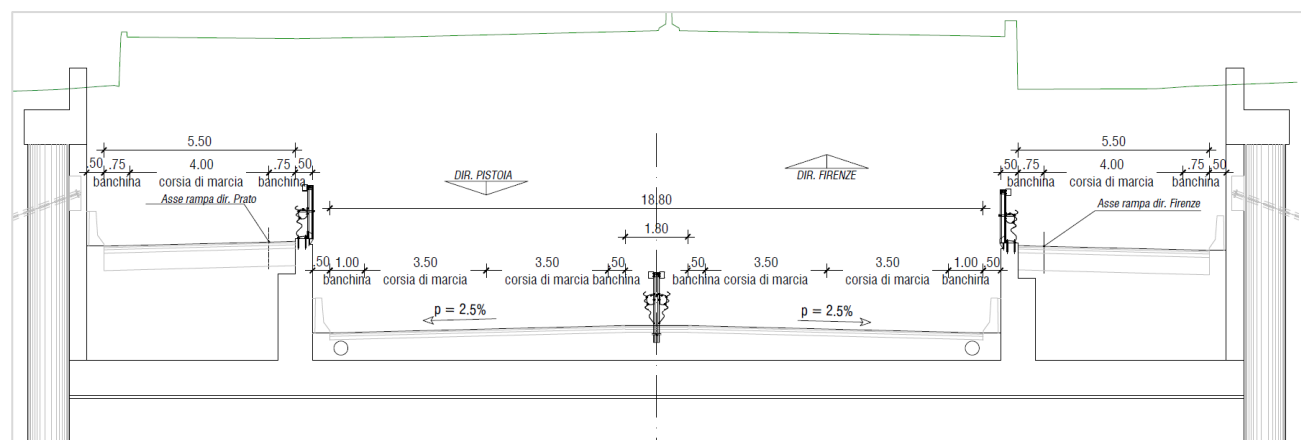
Sezione tipo "ASSE PRINCIPALE CON RAMPE IN AFFIANCAMENTO"
